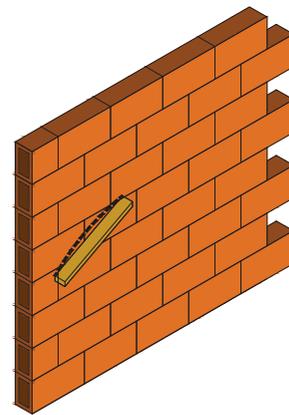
Tolerancias para planeidad de tabiques en base a bloques (Fuente: CDT, 2013).
